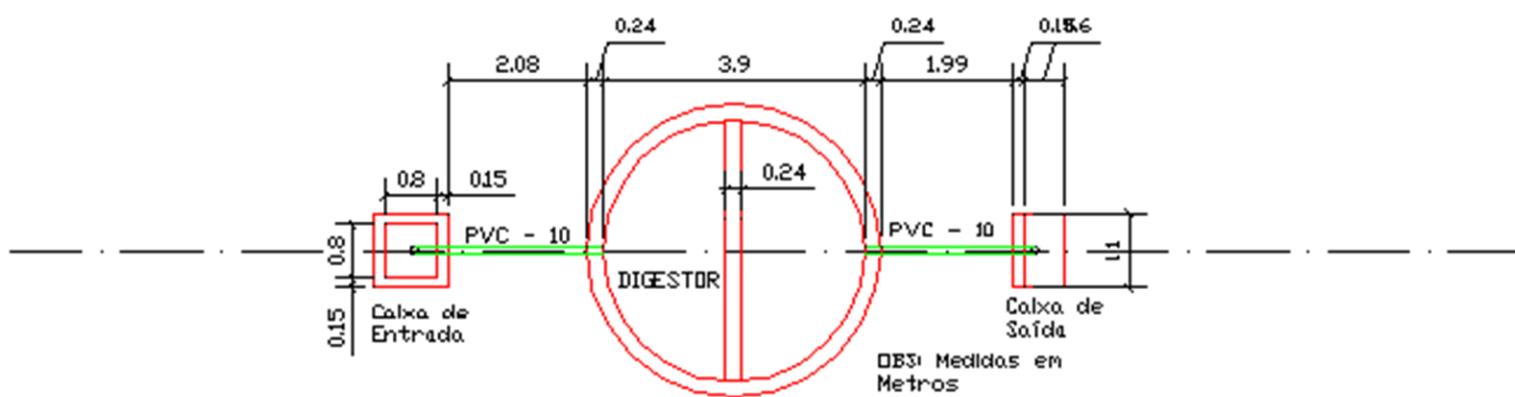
Projeto Planta baixa do Biodigestor Vertical (Modelo Indiano).
